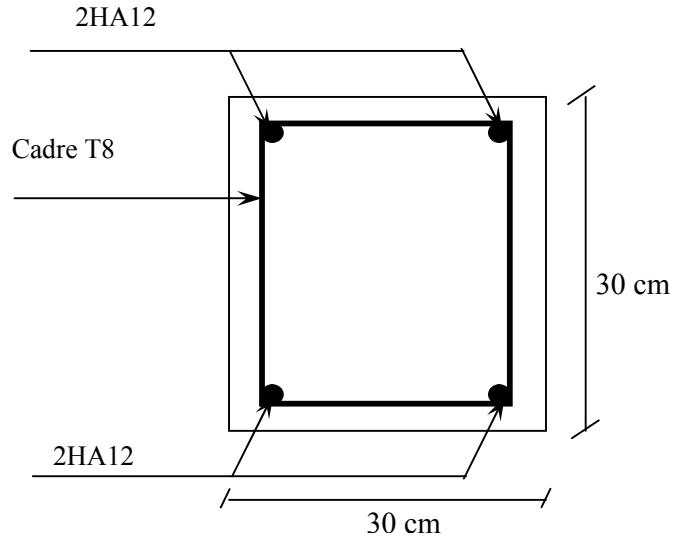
Schéma de ferrailage de la console de l'escalier.
